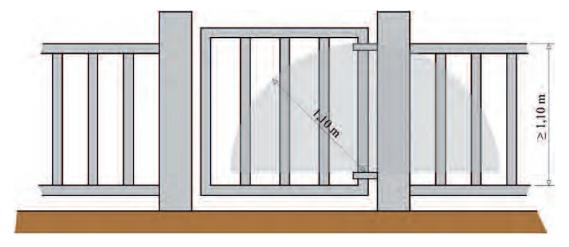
EXEMPLES DE DÉTERMINATION DE LA HAUTEUR MINIMALE
